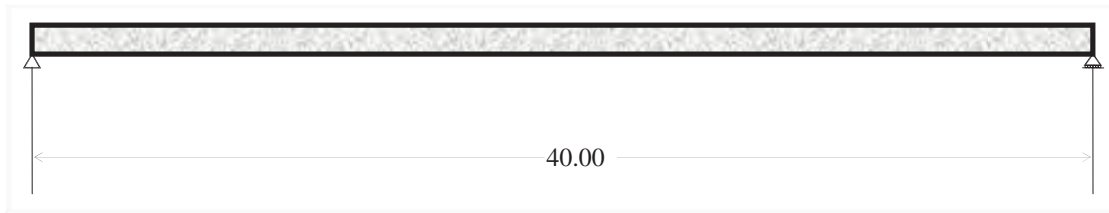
Tipo de apoyo y su longitud entre ellos.
